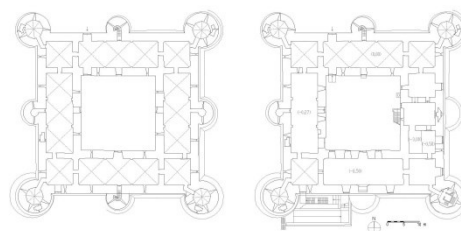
Il castello Ursino, a sinistra la pianta originaria nell'Interpretazione di Agnello, a destra lo stato attuale
